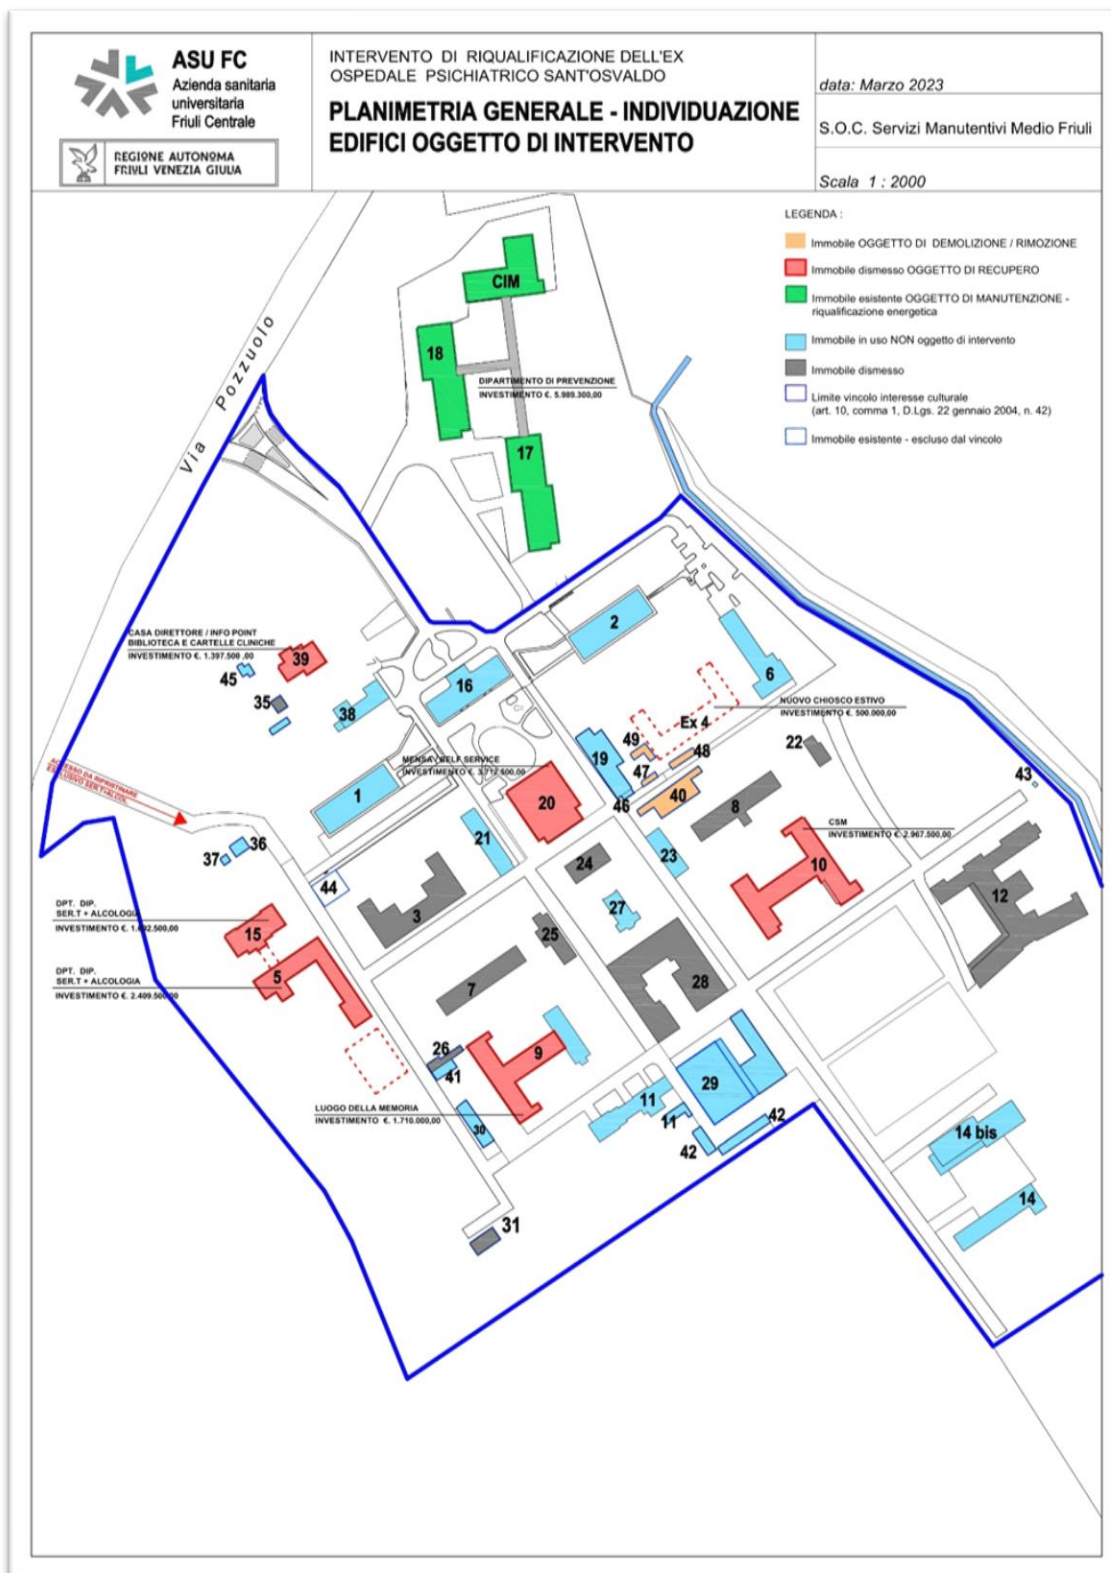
Planimetria generale - individuazione edifici oggetto di intervento
